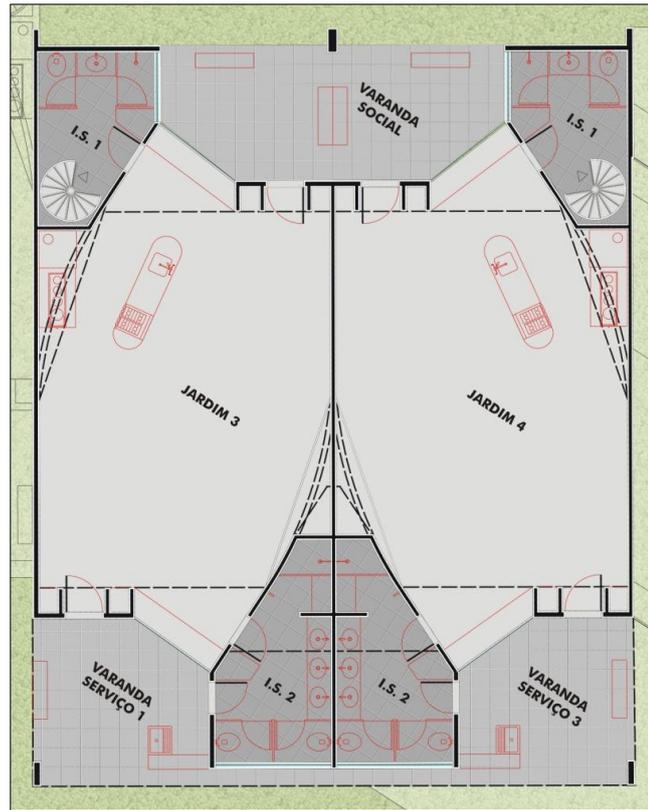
Planta 1º Pavimento - Escola Pólen.
